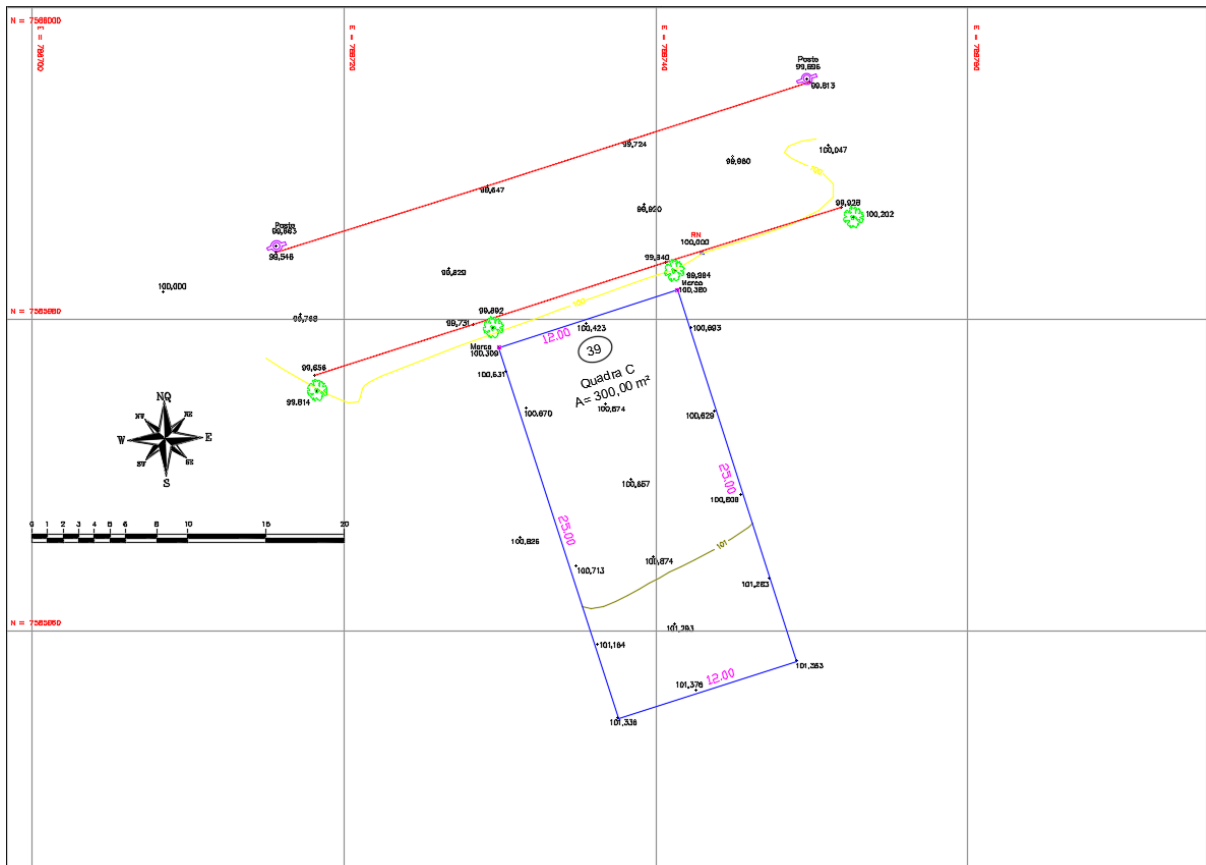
Estudo de Caso: Levantamento Topográfico de um Terreno
